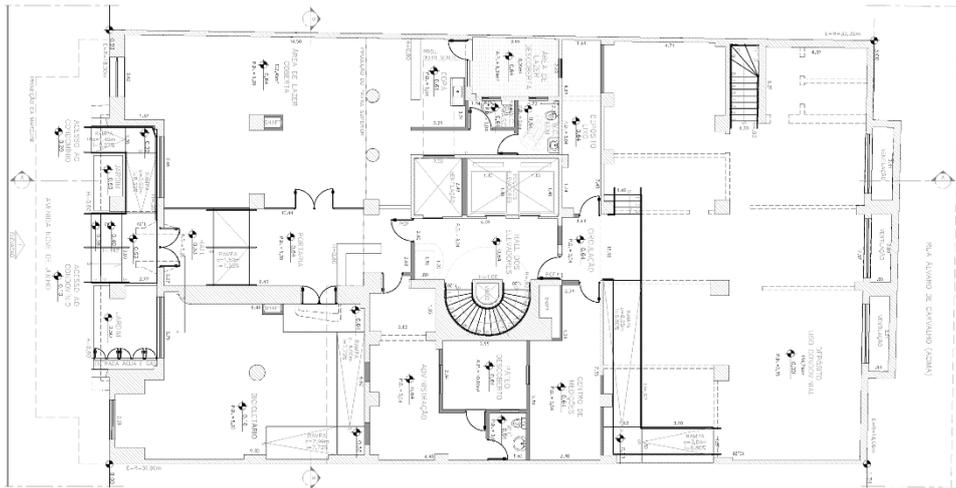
Planta térreo, projeto COHAB. Fonte: COHAB
